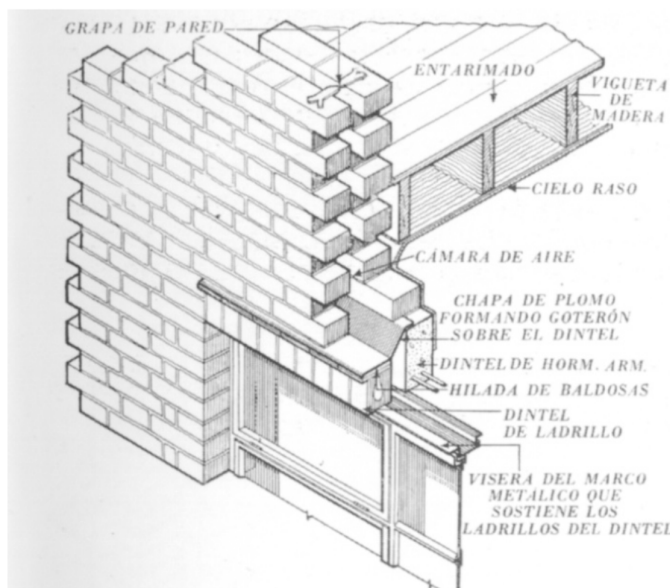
Detalhe Construtivo Cavity Wall. Fonte: (Poyatos, 2010).
